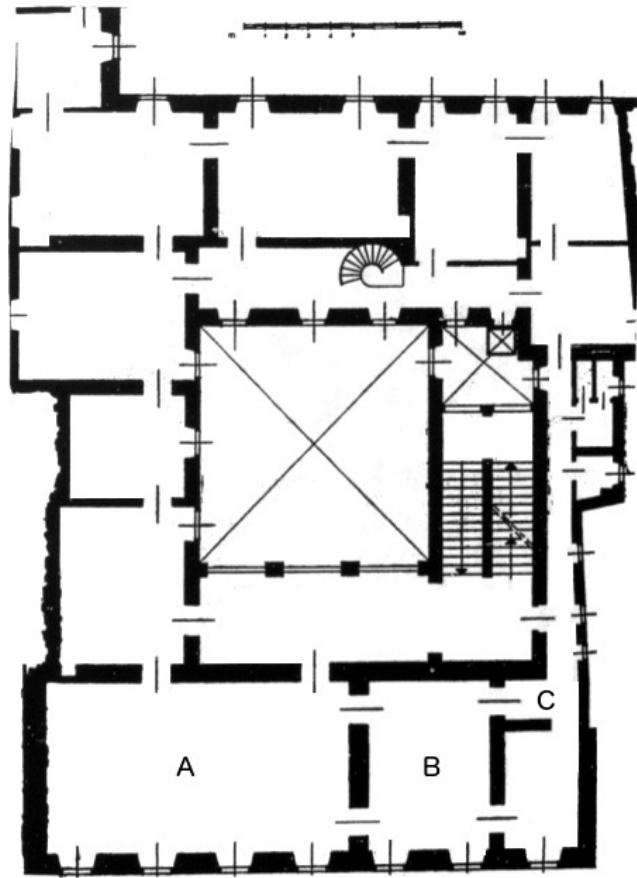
Palazzo Baldassini, Grundriss des ersten Stockes, Salone (A), Studiolo (B), Stufetta (C), nach WOLK 1987, 467, Abb. 51.
